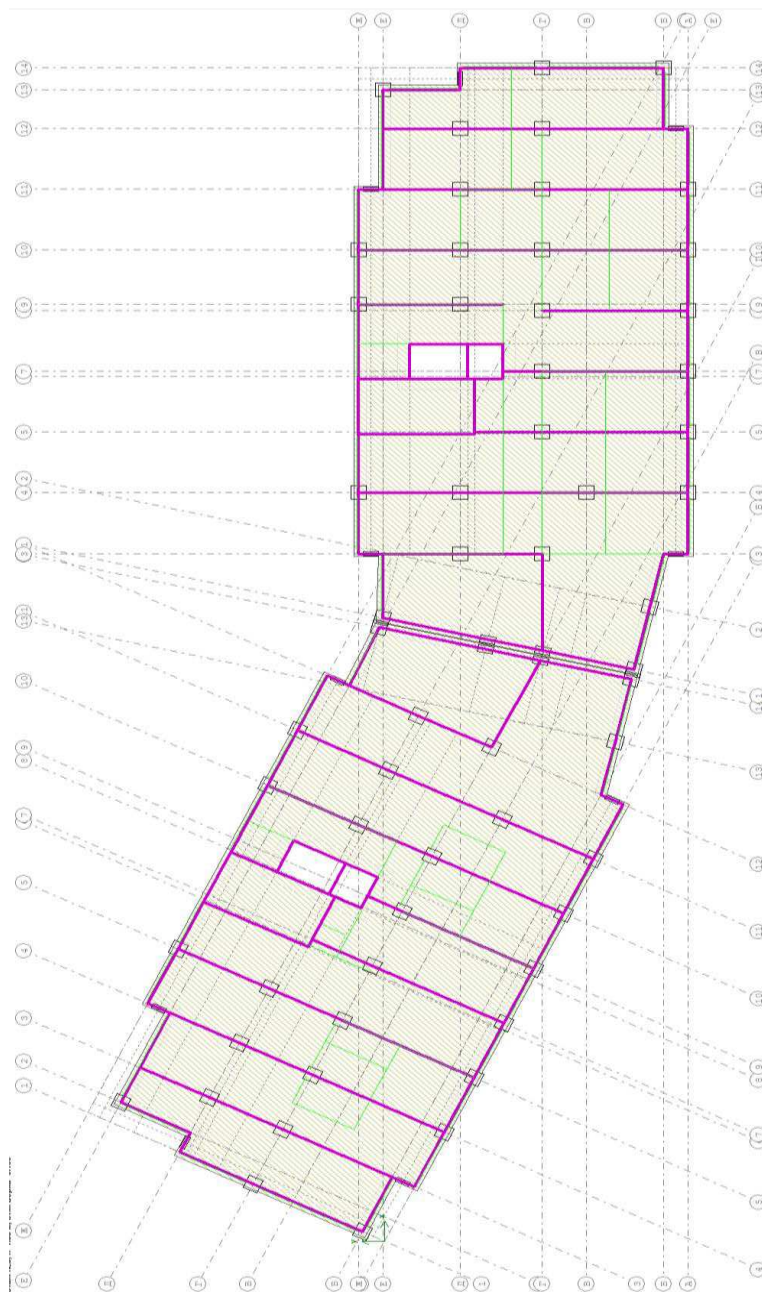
Схема расположения плит перекрытия, колонн диафрагм жесткости и перегородок над подвалом
